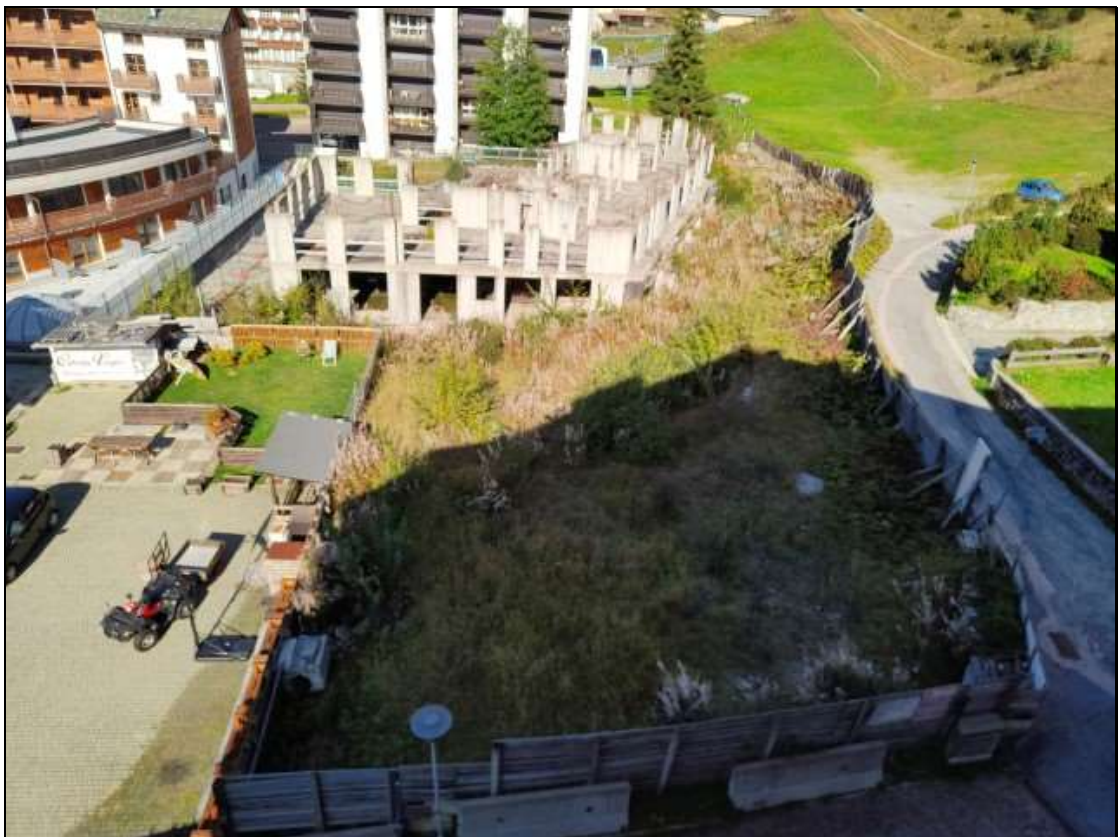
Area di cantiere vista da sud (vista dall'alto)
